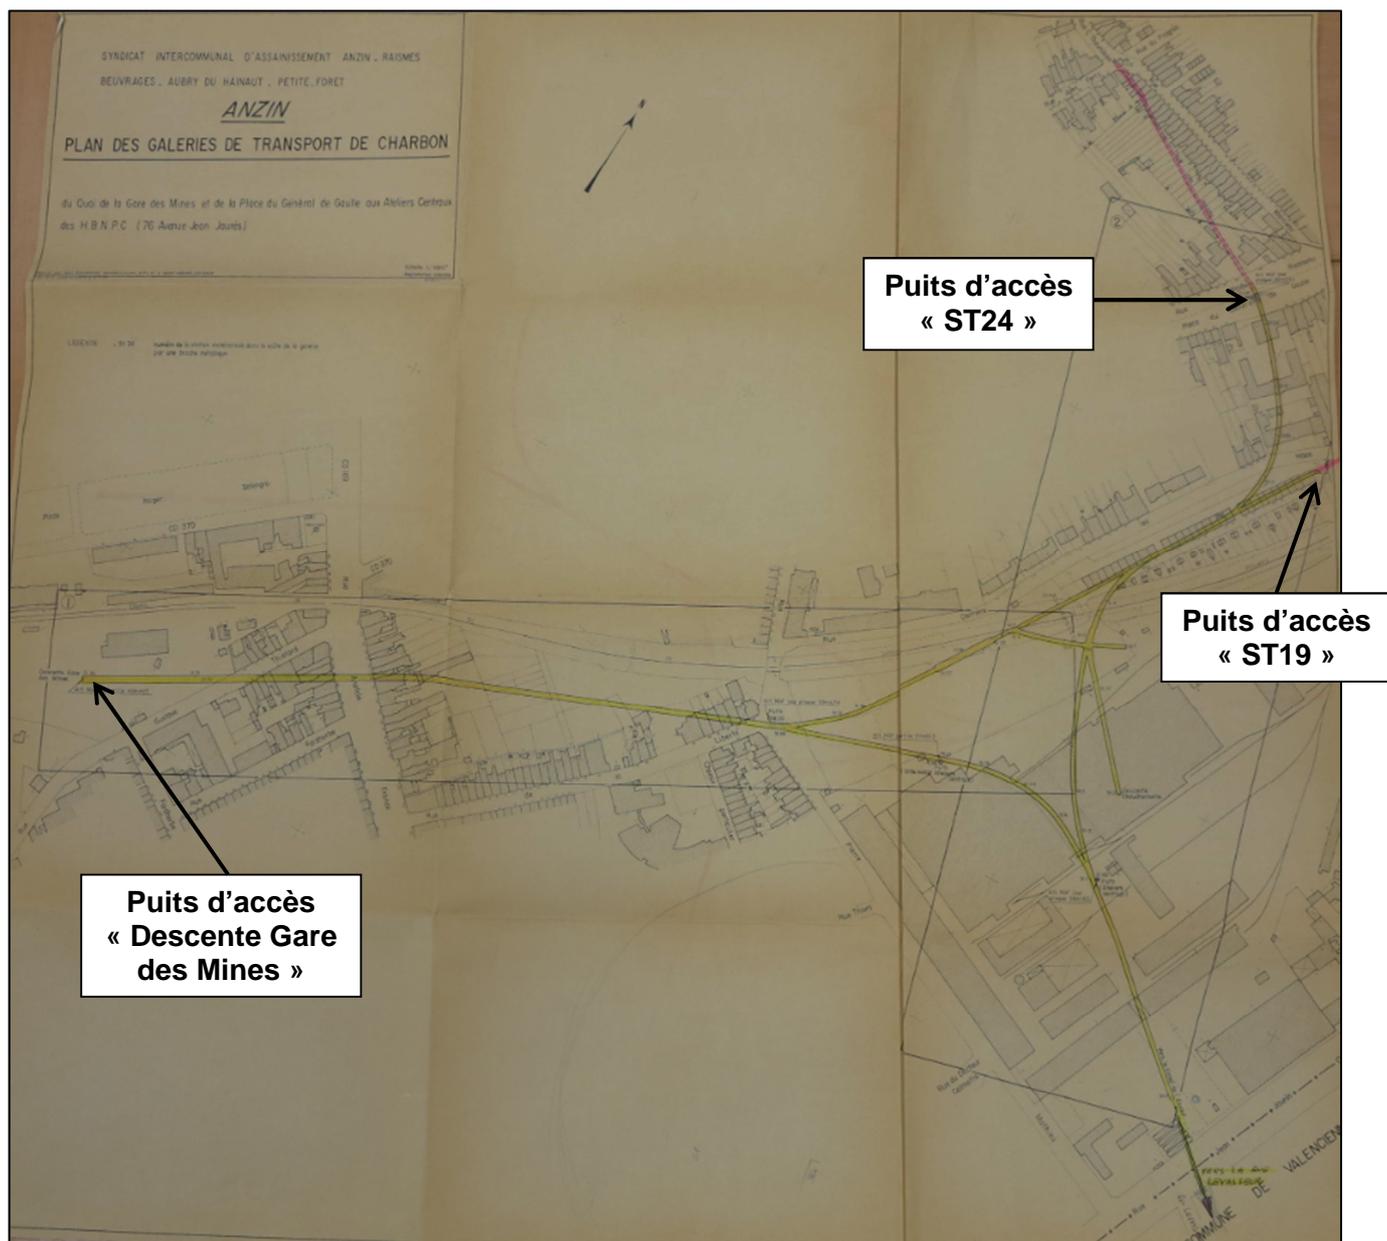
Photographie du plan du tunnel d'Anzin - en jaune le tracé utilisé comme réseau d'assainissement des eaux pluviales par le SIARB
